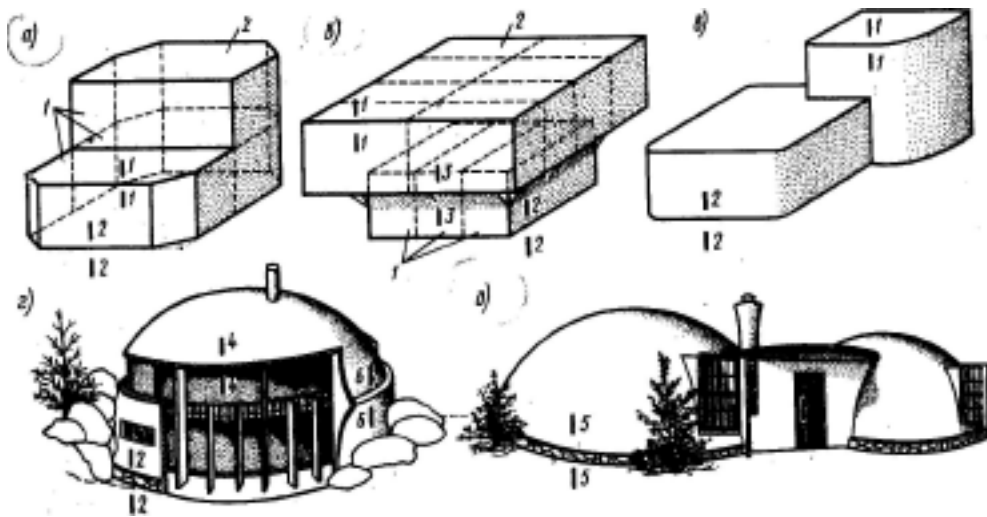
Примерные схемы нестандартных решений малоэтажных жилых домов из монолитного бетона:
